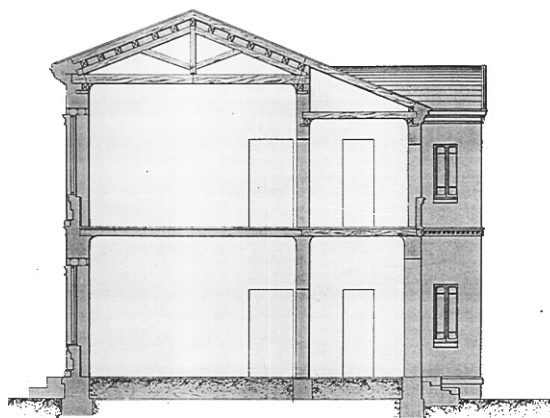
Sección del CEIP Macías Picavea. Ayuntamiento de Valladolid.
